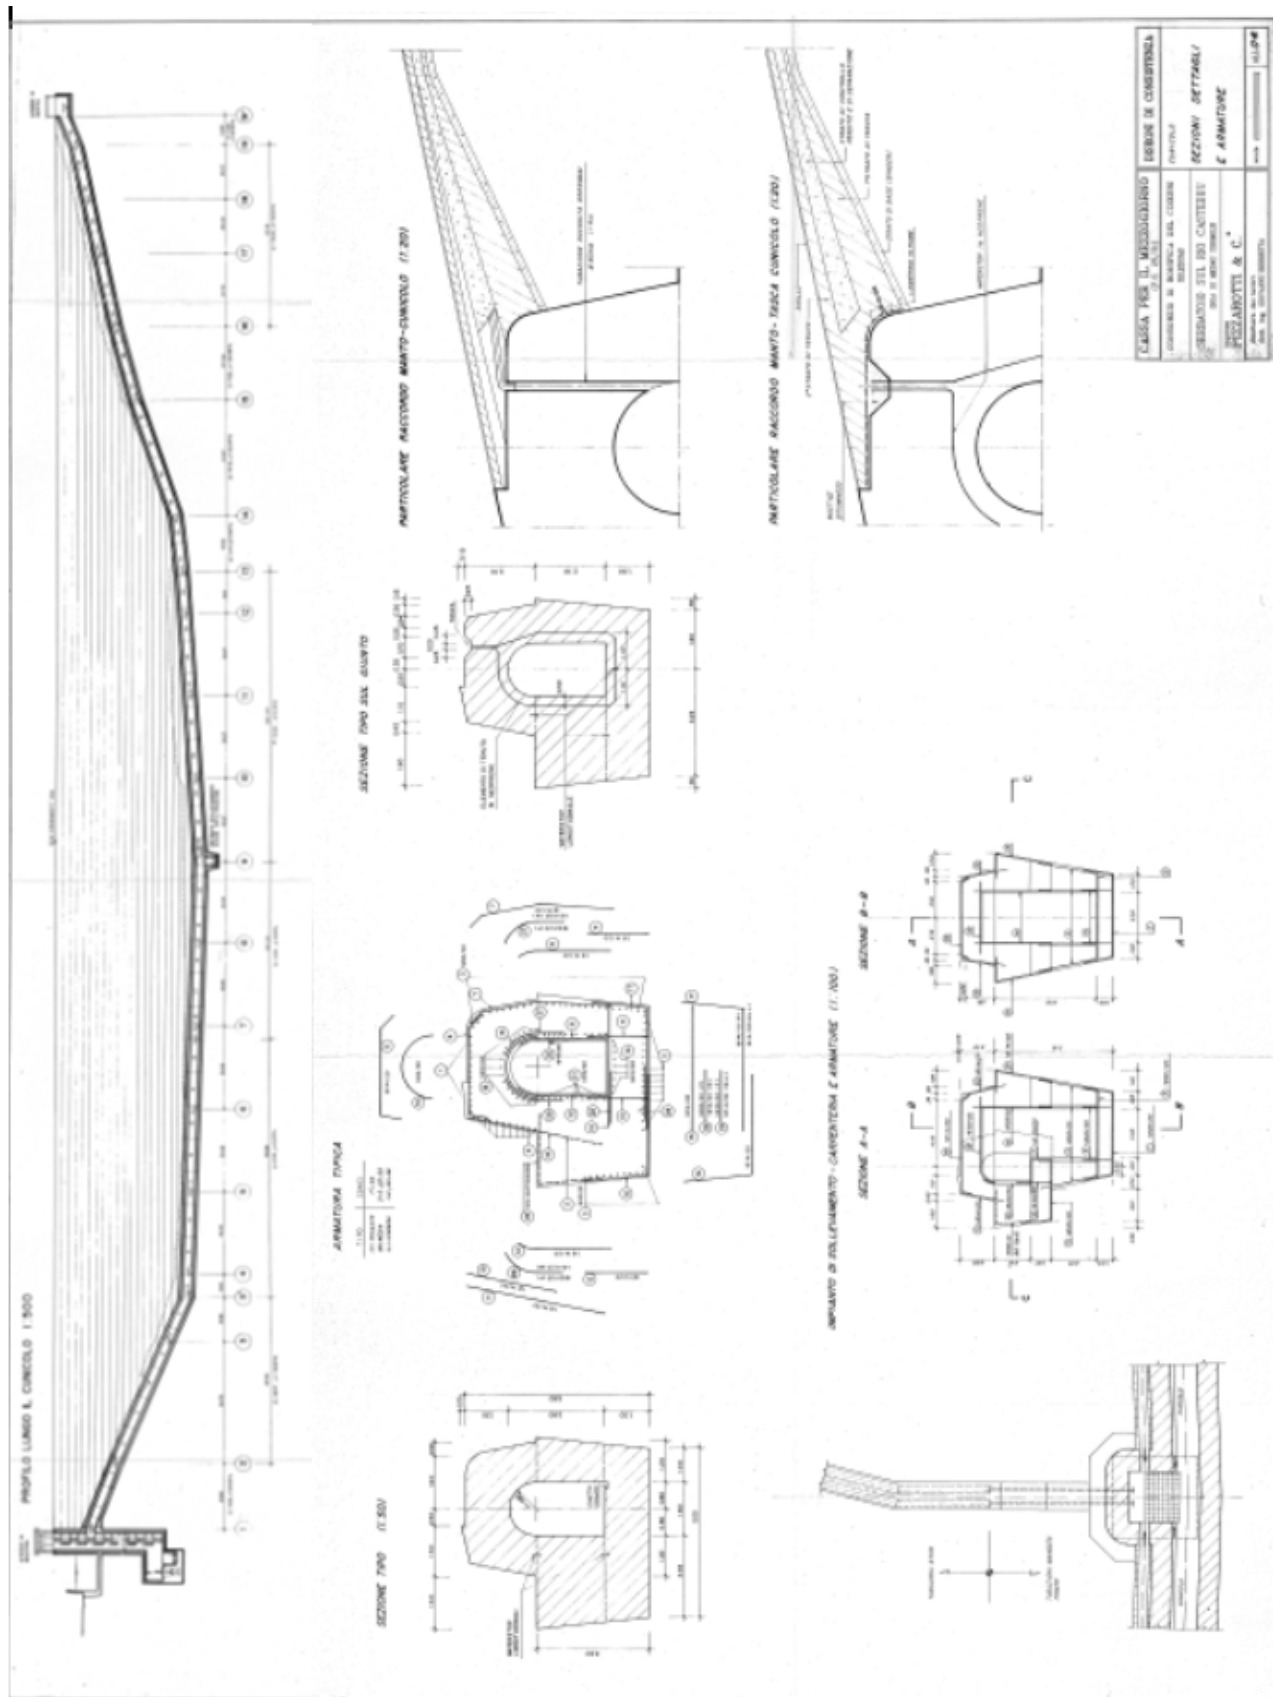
Medau, Galleria d'ispezione, Profilo longitudinale e sezione tipica
